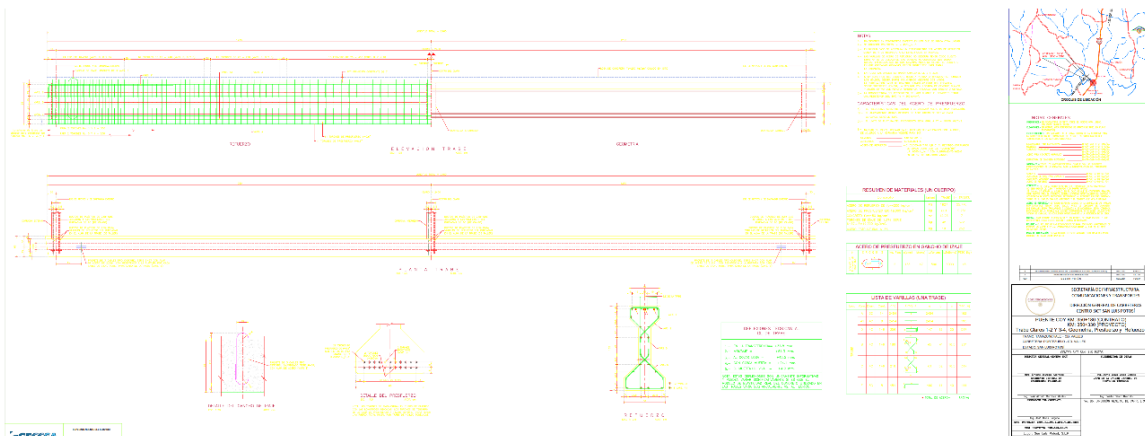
Plano losas no. 2. (Elaboración de equipo topográfico y estructural)
